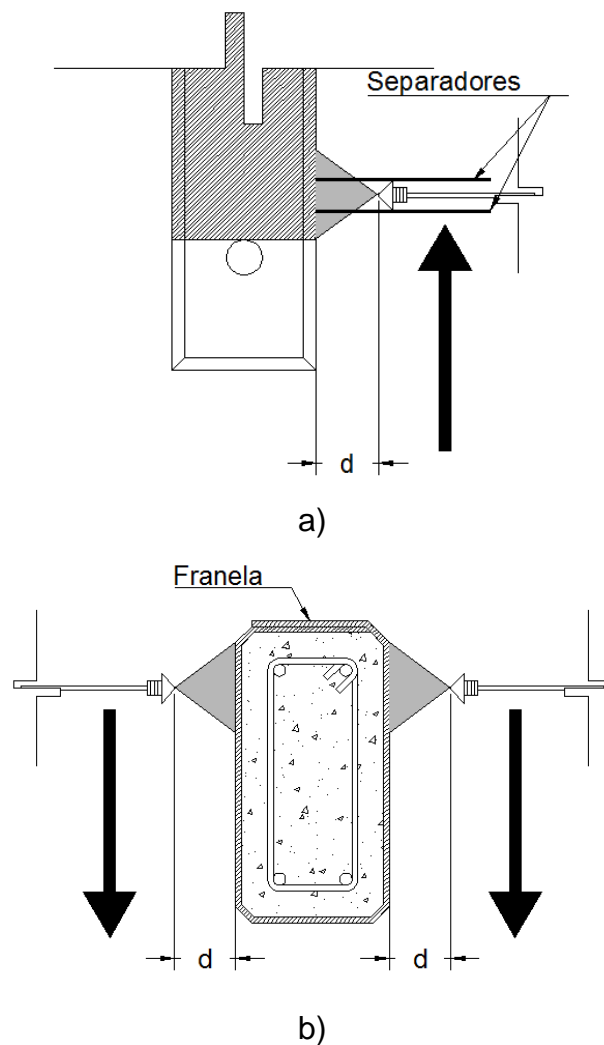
a) Detalle en planta de aplicación de solución con cloruros, b) Detalle transversal de aplicación de solución con cloruros
